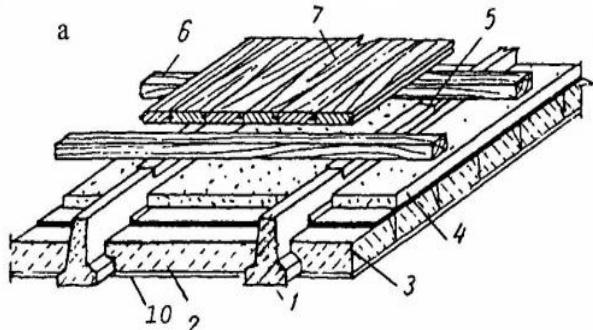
Перекрытие по железобетонным балкам таврового сечения
